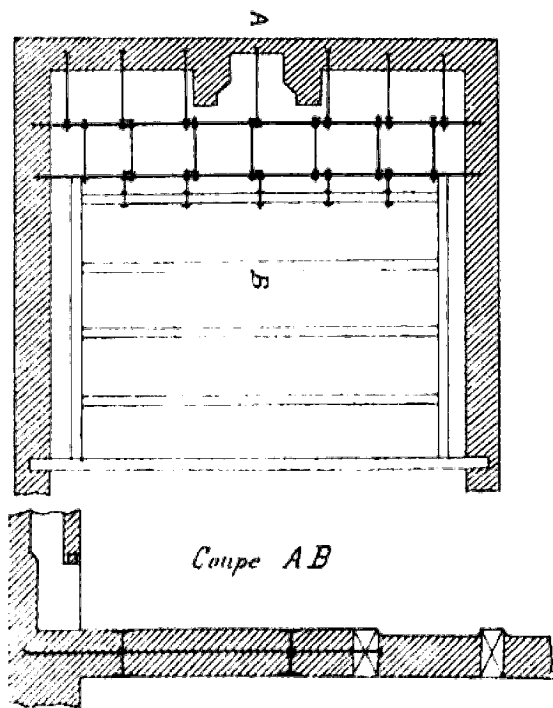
Disposition d'un plancher mixte avec solives d'enchevêtreure parallèles au mur du foyer.
